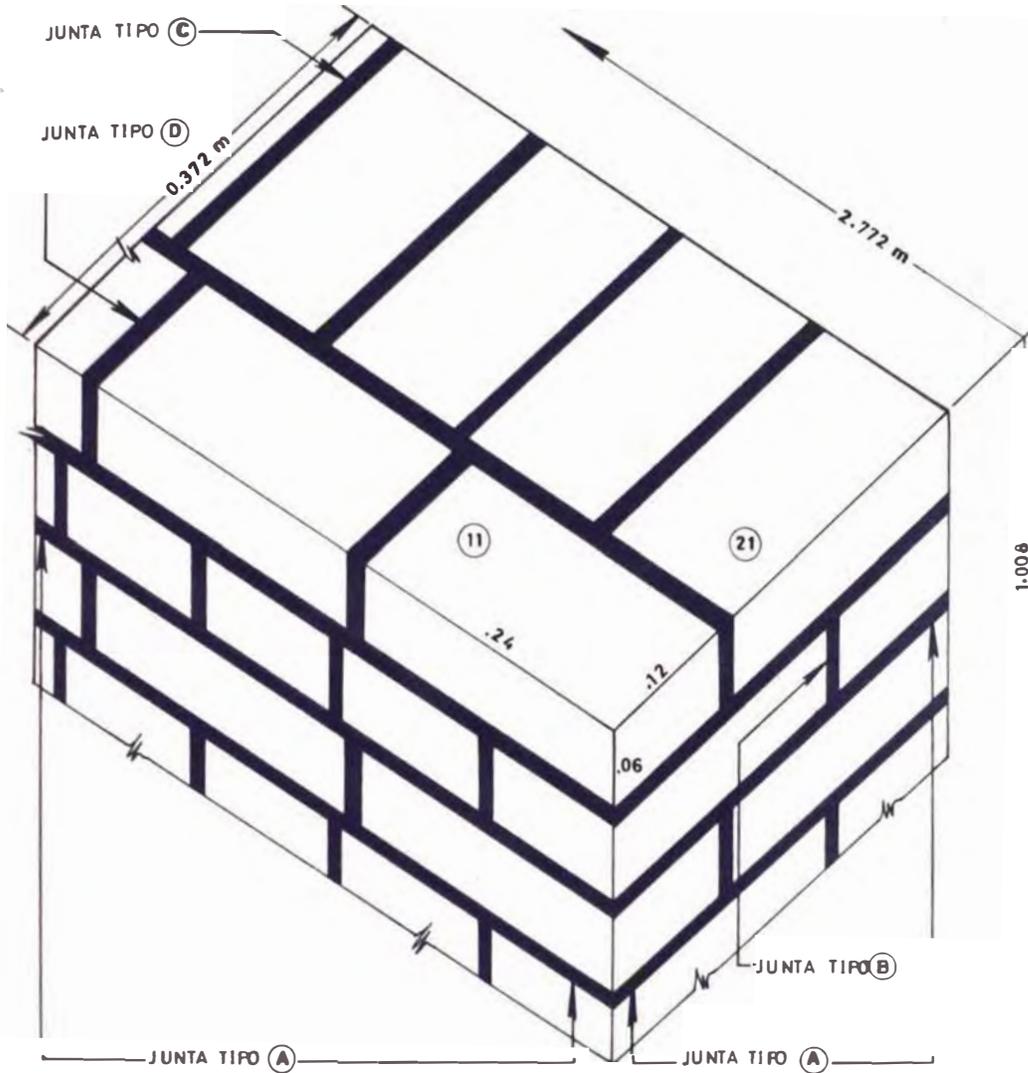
a MURO DE 1 1/2 LADRILLO CORRIENTE (Perspectiva)
